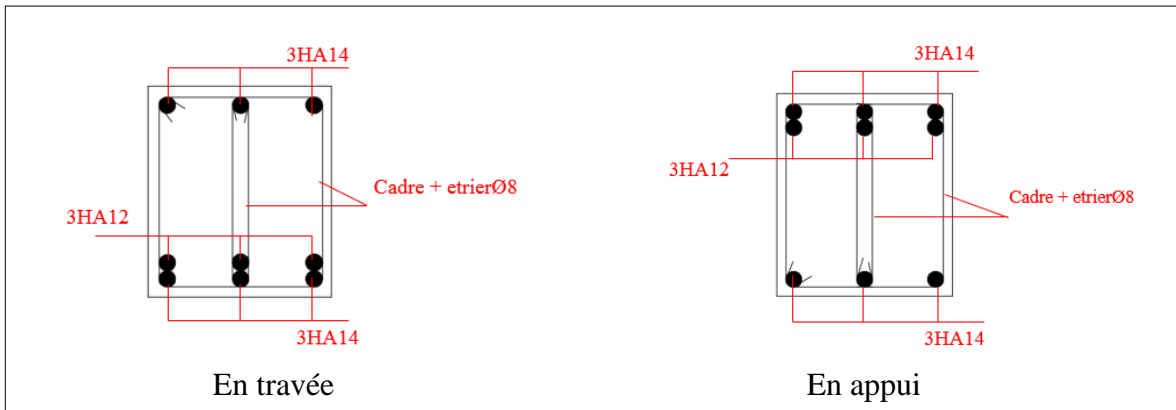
schéma de ferrailage de la poutres principales 2^{eme} et 3^{eme}, 4^{eme}, 5^{eme} étages.
